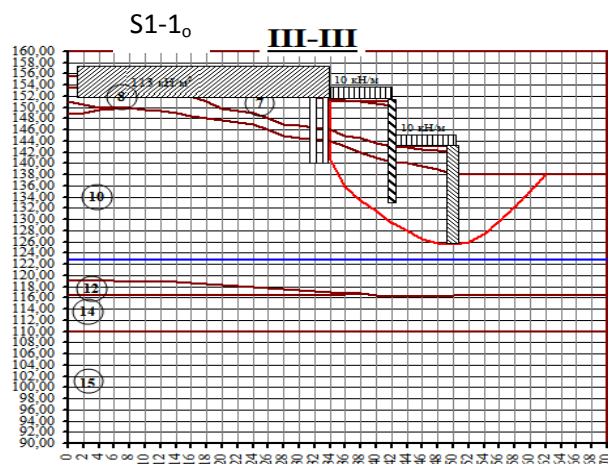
Расчетная схема устойчивости подпорных стен для сечения S1-1_o
